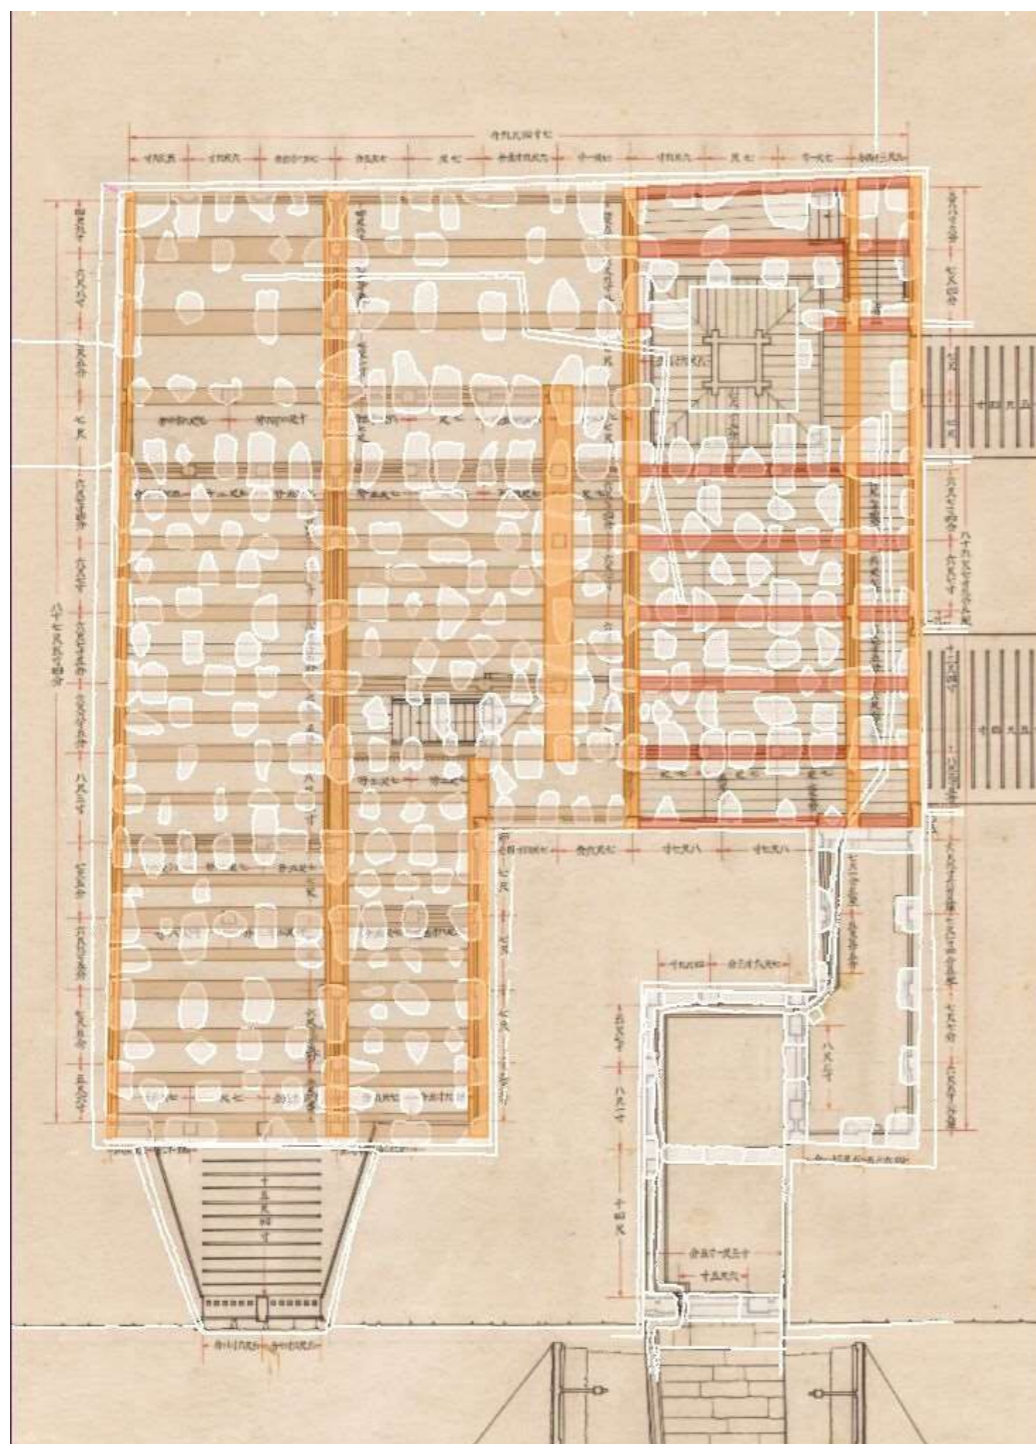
「天守礎石配置図」と昭和実測図「地階平面図」の重ね合わせによる礎石配置図の確かさの検証
